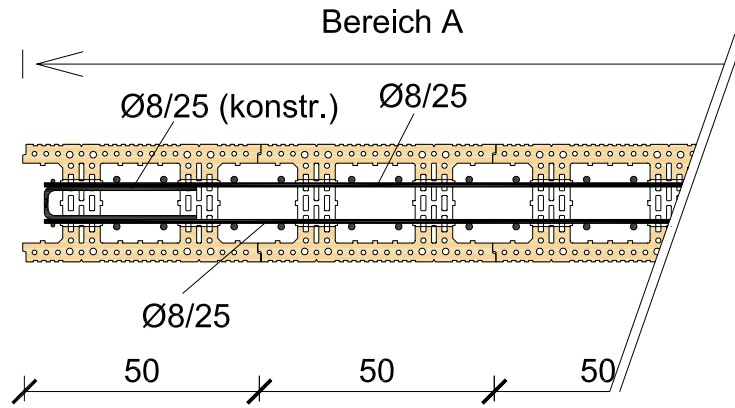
Bewehrungsskizze (horizontale Lagerfugenbewehrung)
